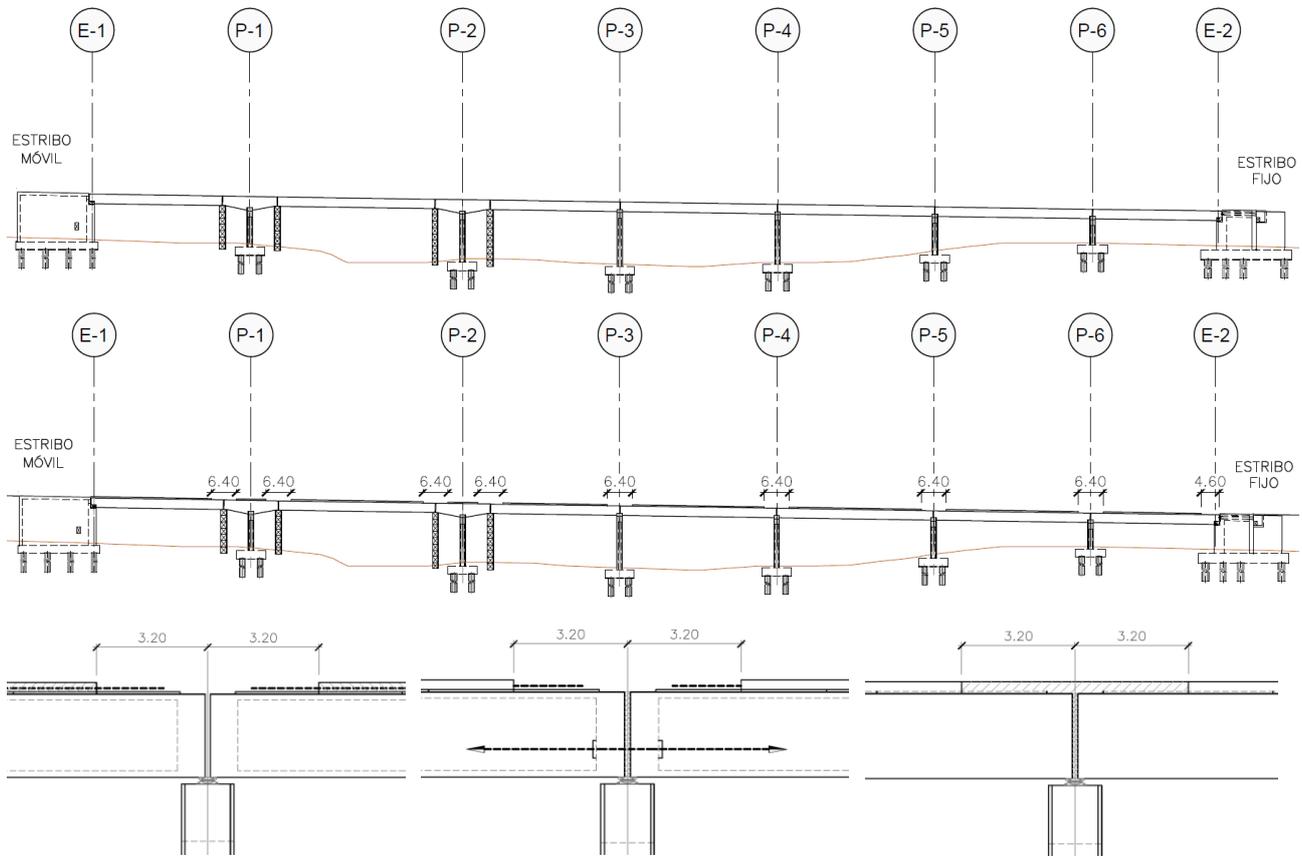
Alzados de proceso constructivo. Viaducto sobre Hoya de la Gitana. Alzado superior para fases 1 y 2, alzado intermedio para fase 3, alzados inferiores para las fases 4, 5 y 7 (véase descripción de fases).
